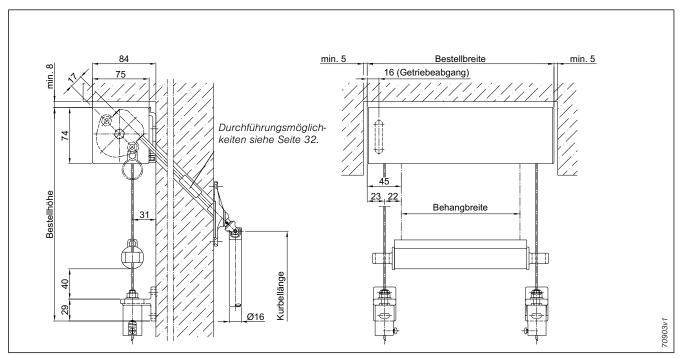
Standardausführung Einzelanlage, Linksroller, Wandmontage; Senkrecht-Markise 470 mit Seilführung
